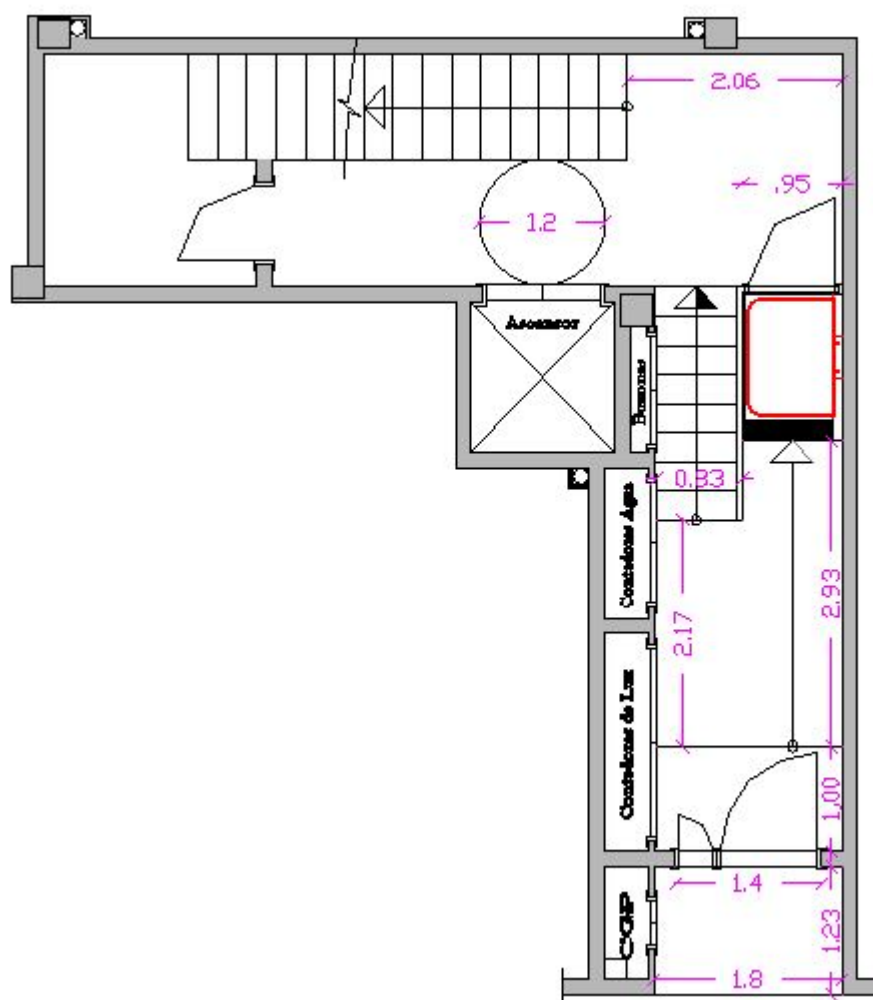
Accesibilidad, recorrido planta baja [Anexo II. Planos]
